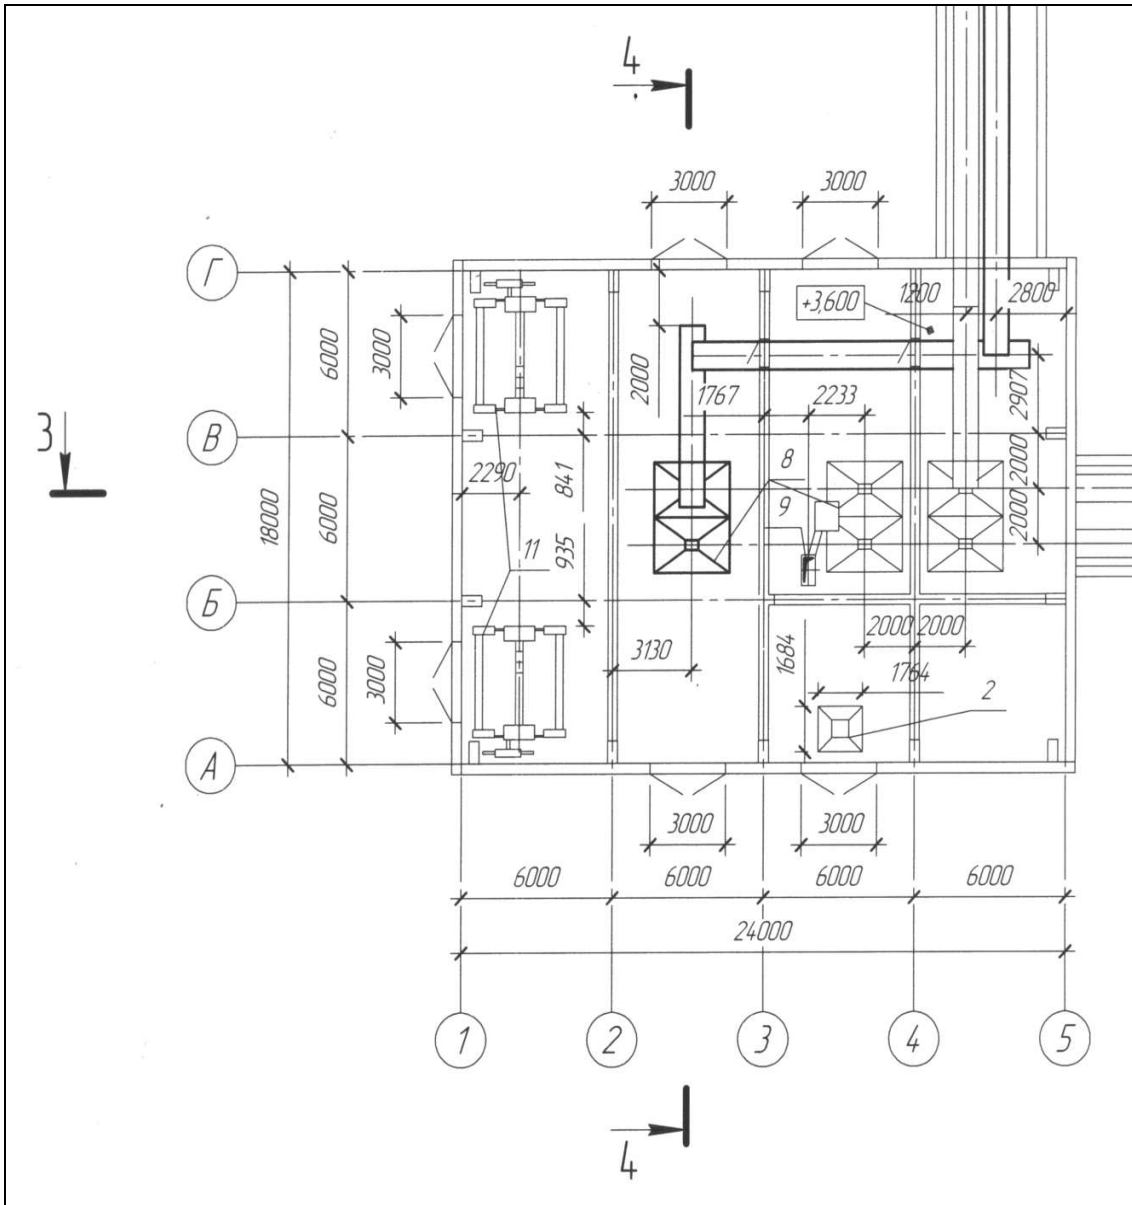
План массозаготовительного цеха аглопорита на отм. +3,600 (двухэтажное здание)
